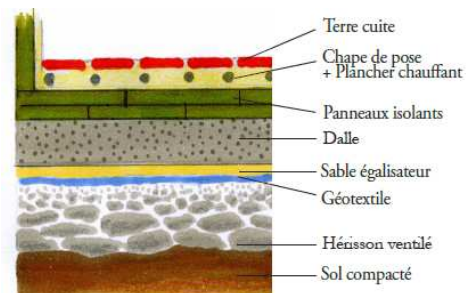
mise en œuvre plancher chauffant sur complexe avec hérissseon ventilé
